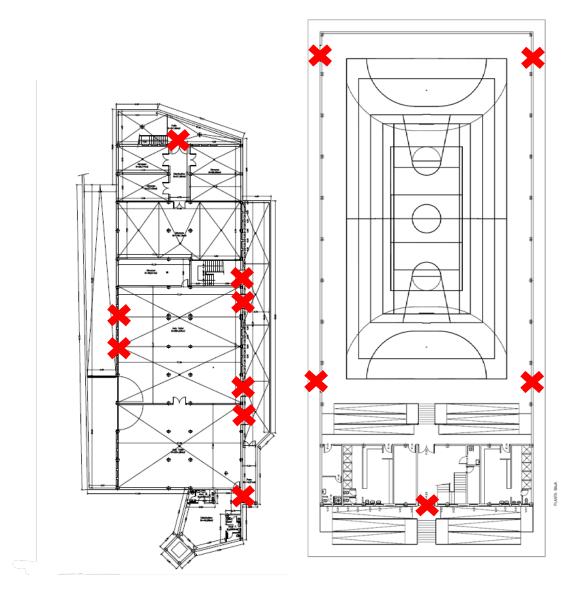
Accesos a proteger con barreras modulares: pabellón docente, planta baja y sótano, y pabellón deportivo
